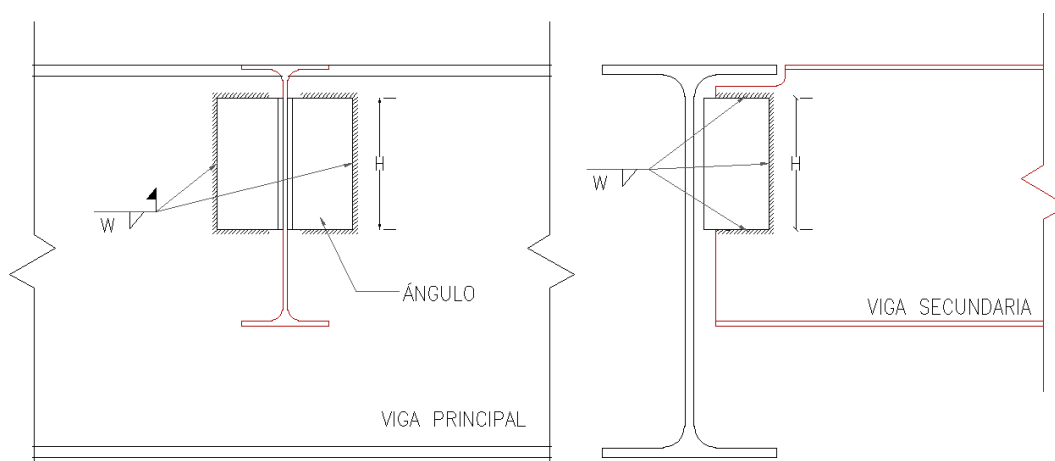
Conexión a cortante entre viga principal y viga secundaria.
